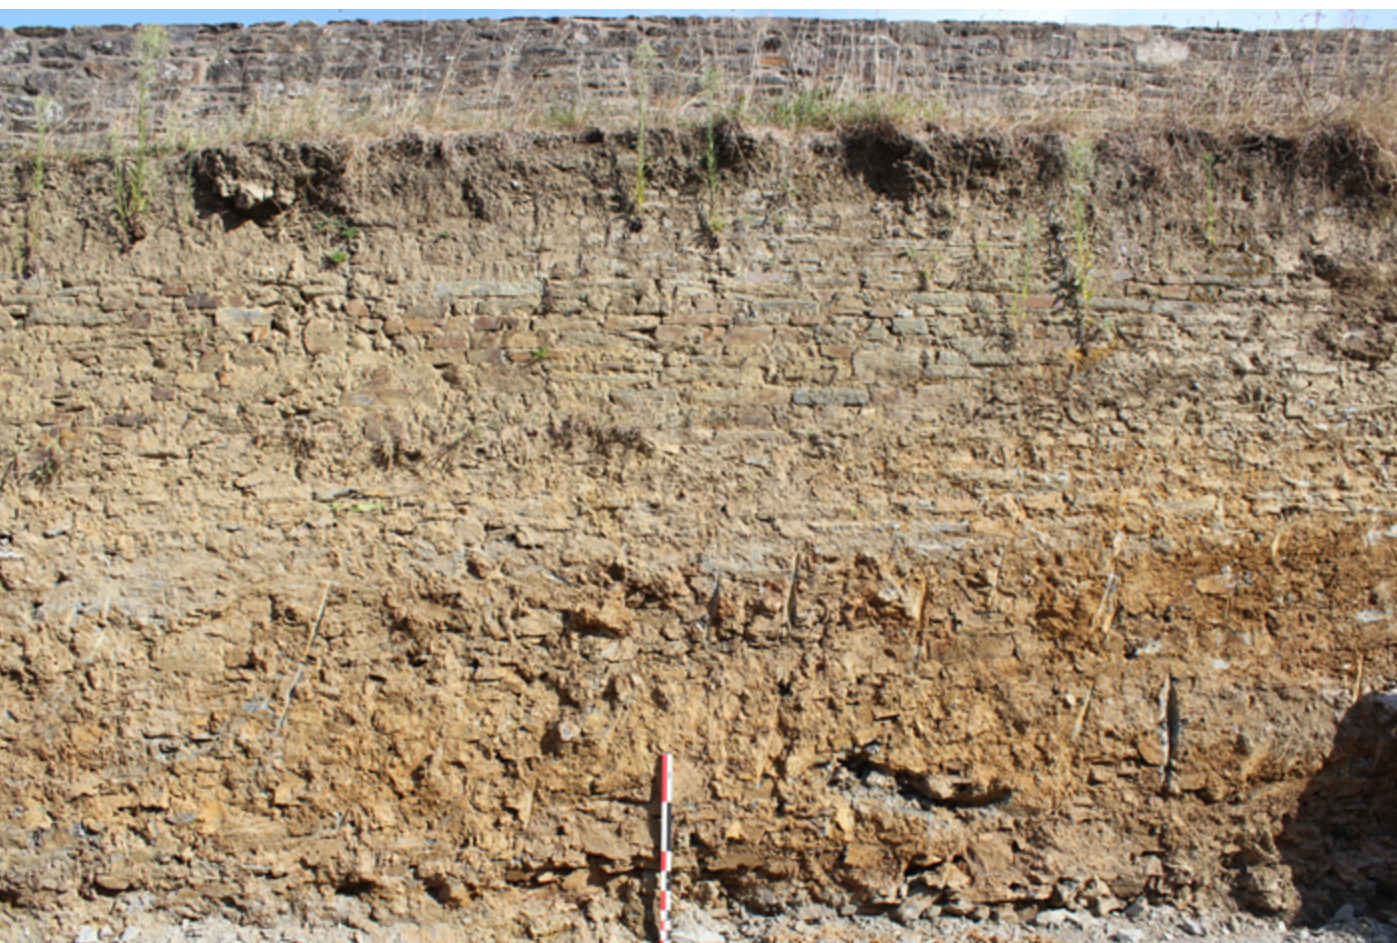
Sc.1, Elévation de M1, face sud (M1.1044)
